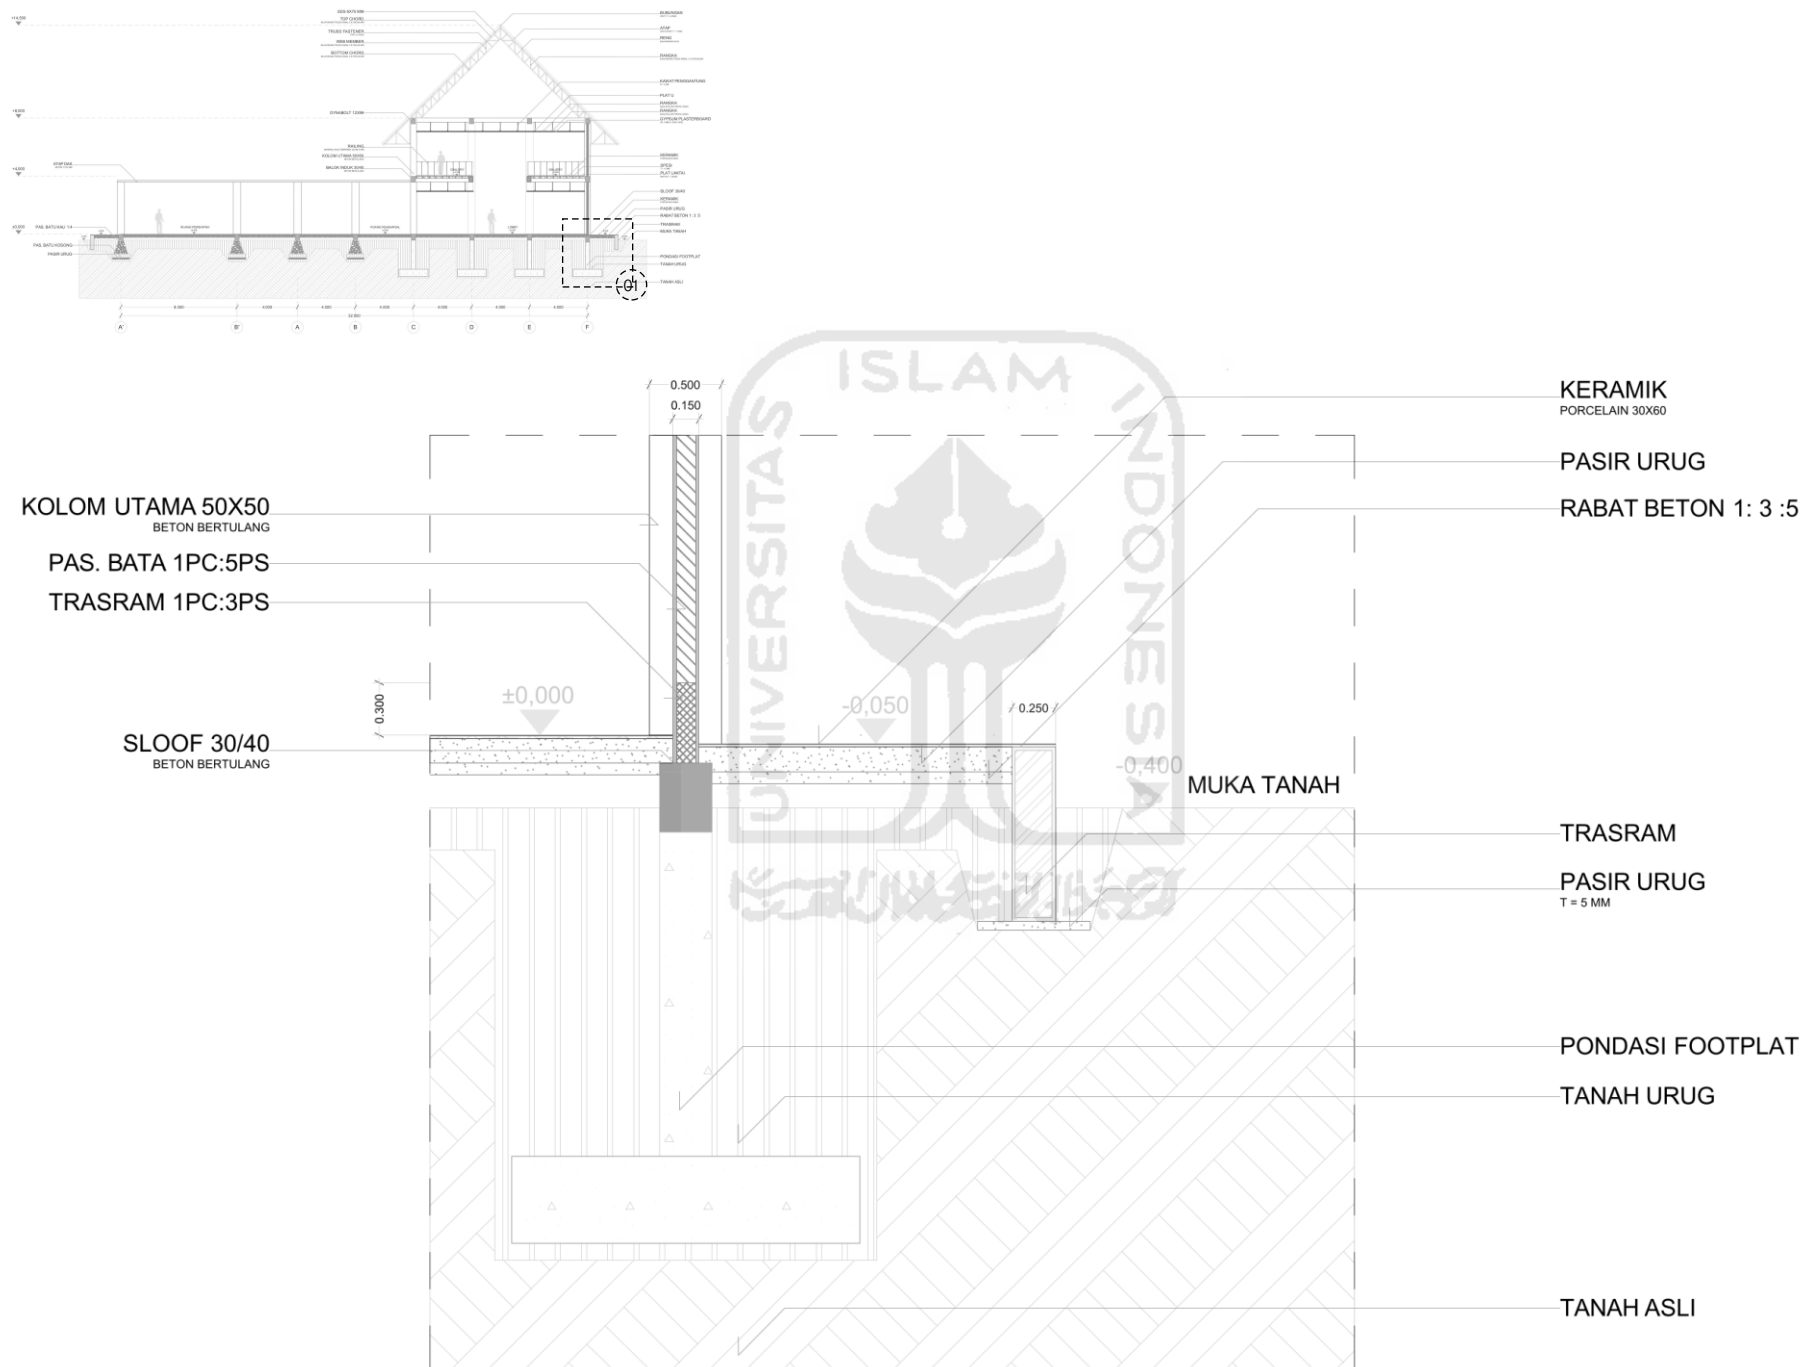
Potongan s-03 bangunan teater (Sumber: Penulis, 2021)
